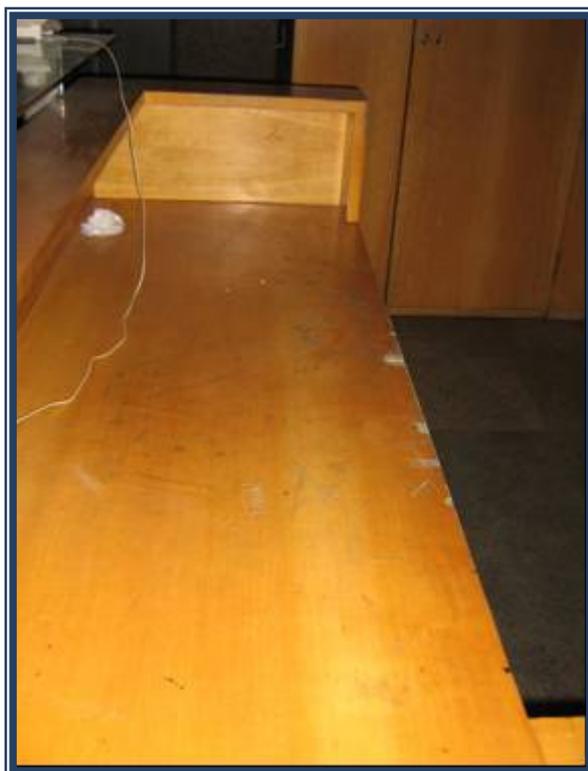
Balcão existente no hall dos elevadores do bloco A em péssimo estado de conservação.
